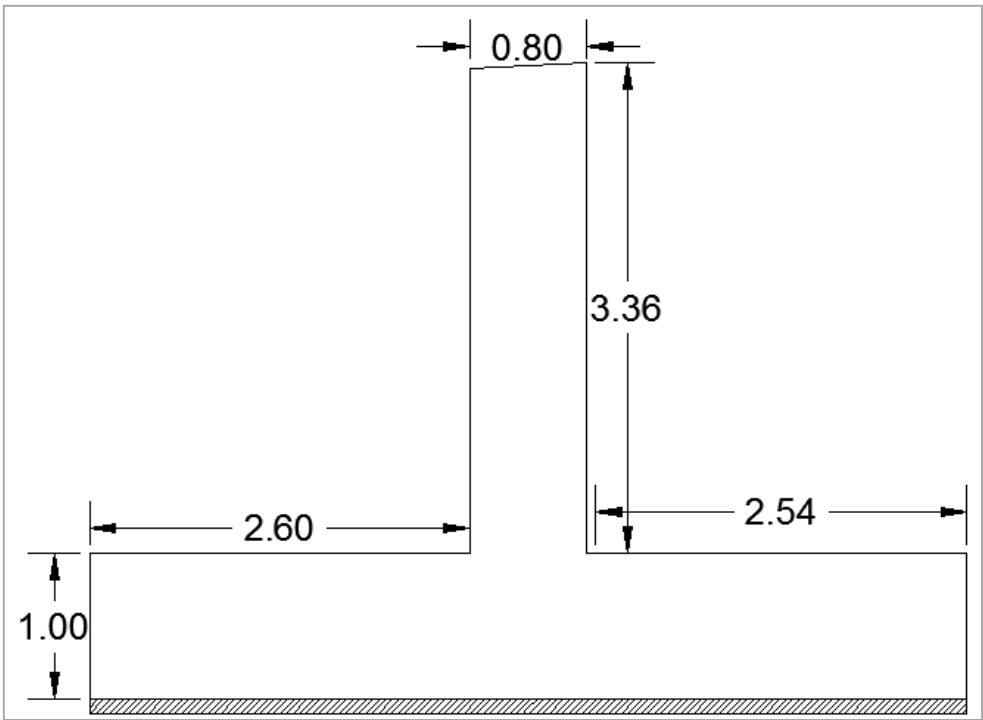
Cotas de sección en estribos. Fuente: Elaboración propia con AutoCAD.
